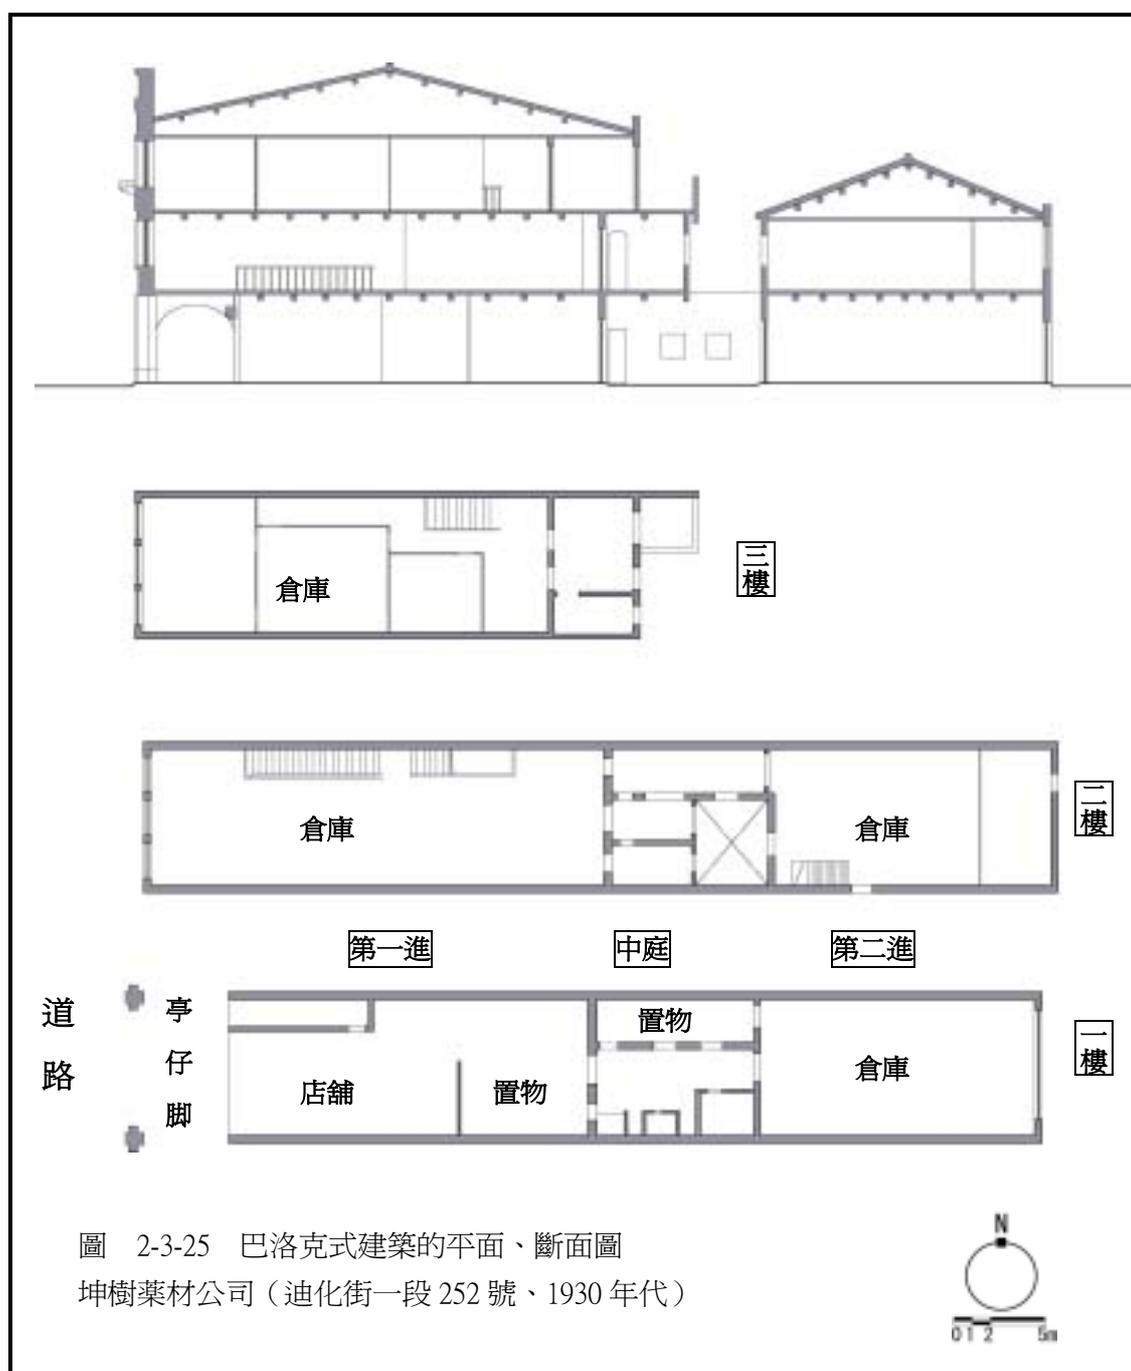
巴洛克式建築的平面、斷面圖
